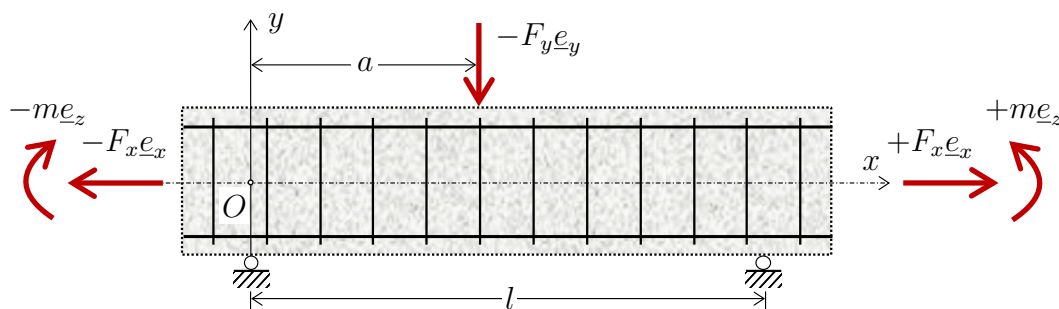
Mode de chargement à trois paramètres de la poutre en béton armé
